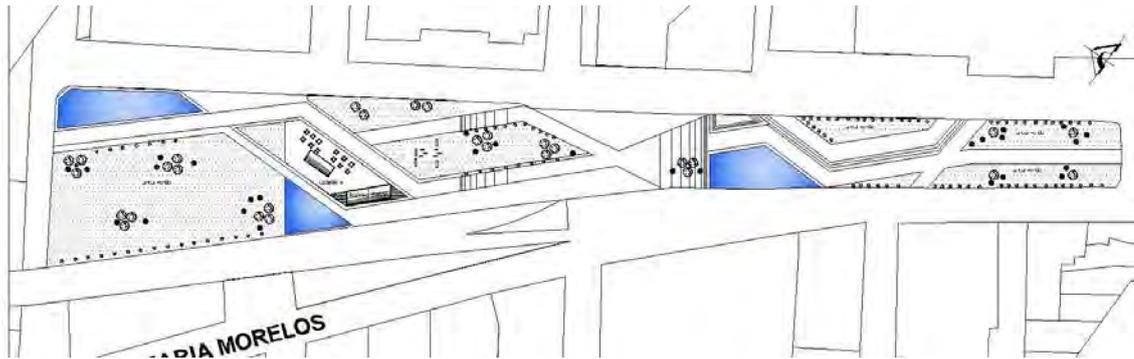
Primera planta del parque lineal como partido arquitectónico.
